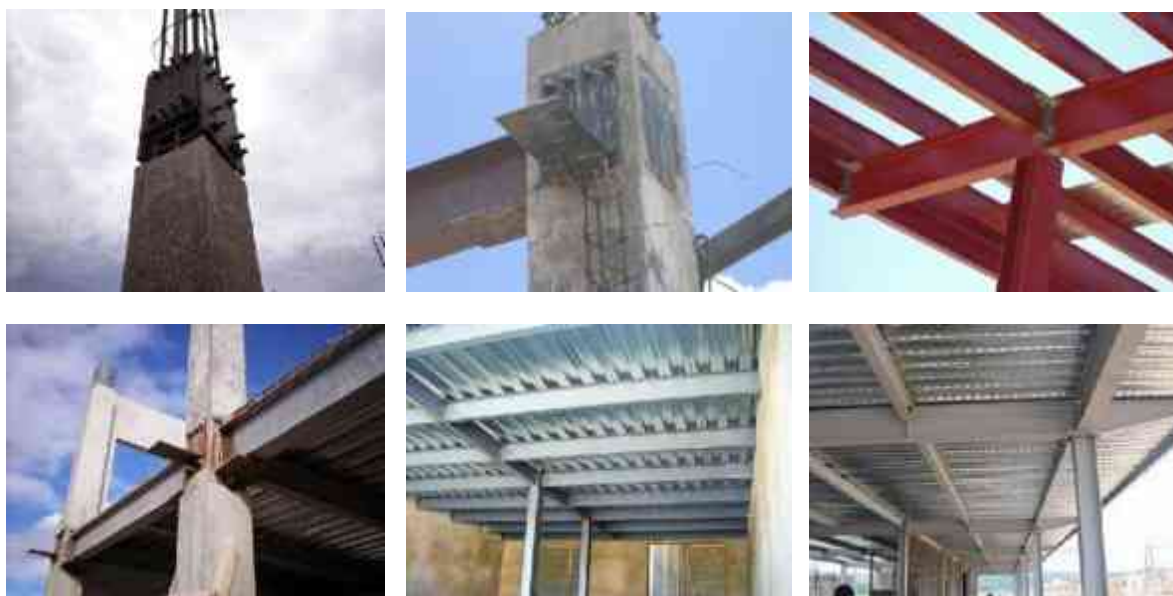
Grupo de fotos obtenidas de google, donde se muestran los distintos procesos constructivos de la super-estructura, la cual está basada en columnas de concreto armado y vigas primarias y secundarias de acero, pudiéndose observar el habilitado de las placas de acero en las columnas de concreto. (<http://www.aguascalientes.gob.mx/> - 10/03/15)
